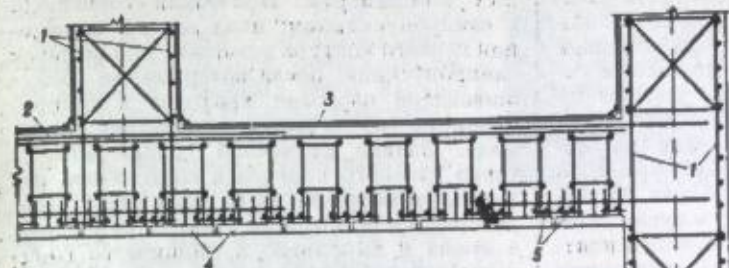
Сборно-монолитное перекрытие, рассчитанное на избыточное давление 3 ат, с использованием сборных плит в качестве опалубки: 1 — фермопакет стены; 2 — рабочая арматура; 3 — распределительная арматура; 4 — сборные железобетонные плиты; 5 — дополнительная рабочая арматура.
